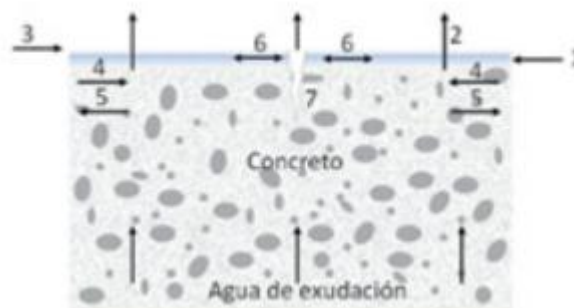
Formación de fisuras por retracción plástica (Aire, 2011)
